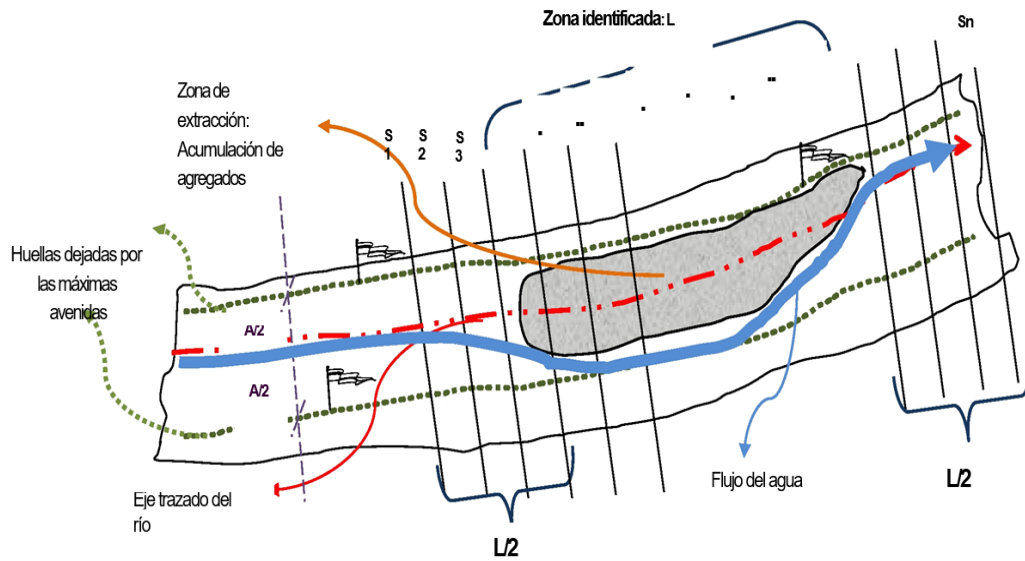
Vista de planta de un río, en donde se ha trazado el eje del río y las secciones transversales
